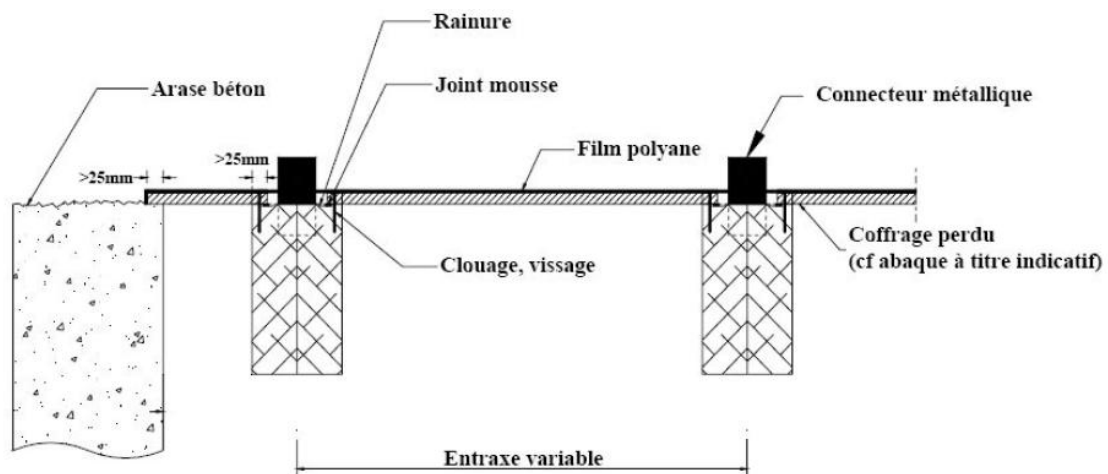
Présentation schématique d'un plancher avec Connecteur Cosylva
